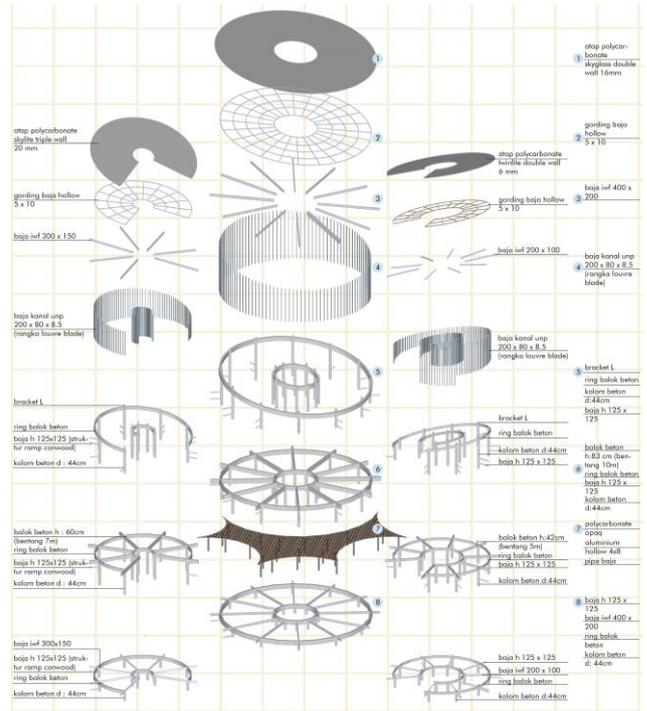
Detail ruang konservatori bunga lantai 2
